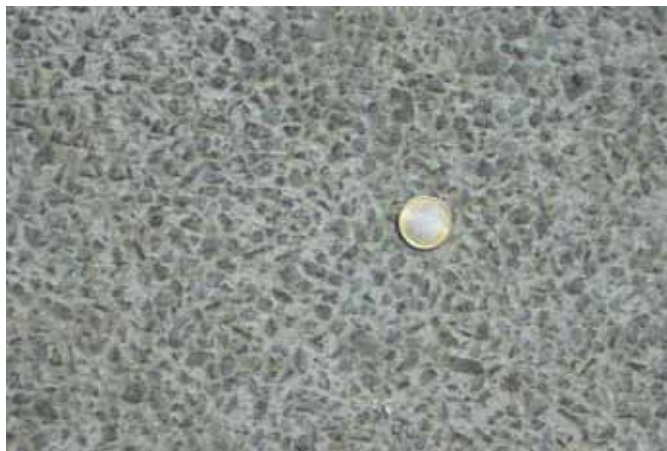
Betondecke mit hochwertiger Waschbetonstruktur
